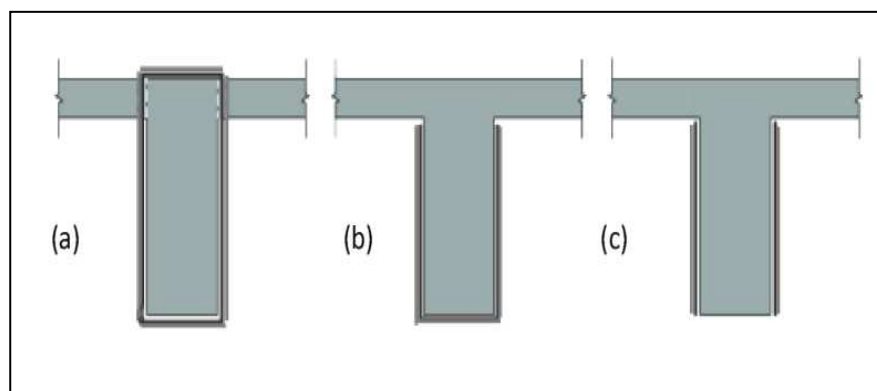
Différentes techniques de renforcement sur une poutre.
